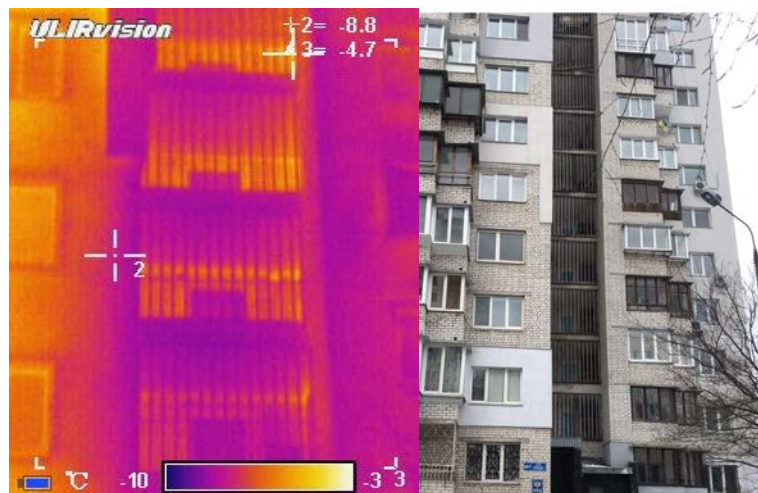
Тепловізійна зйомка фасаду будинку
